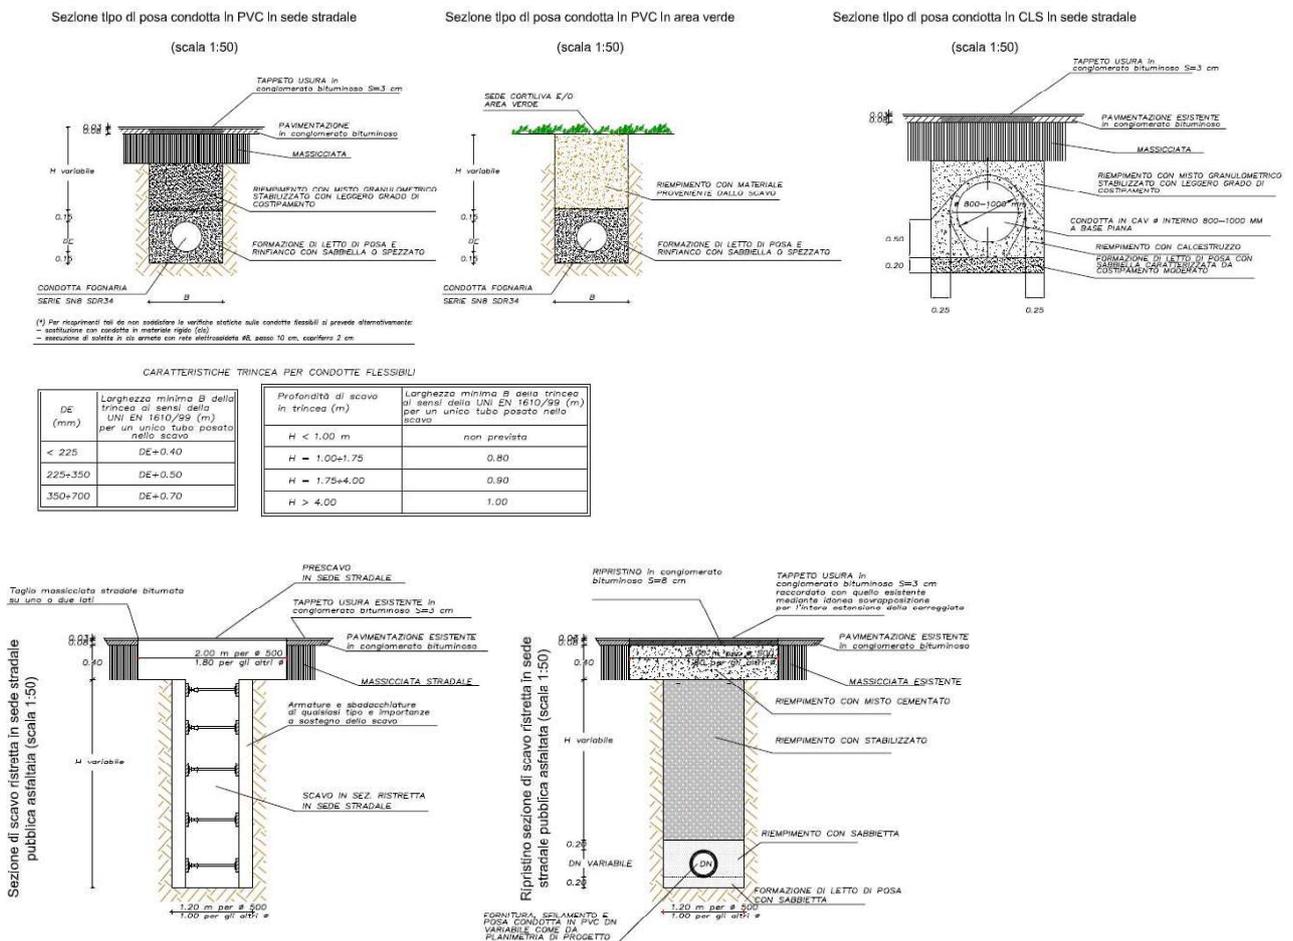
Sezioni tipiche di posa delle tubazioni adottate in progetto.
